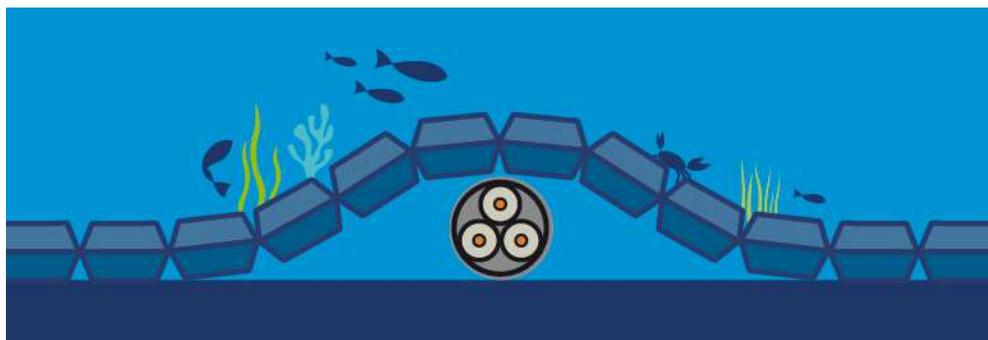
Le matelas béton, autre protection externe possible -Source : RTE, 2016
